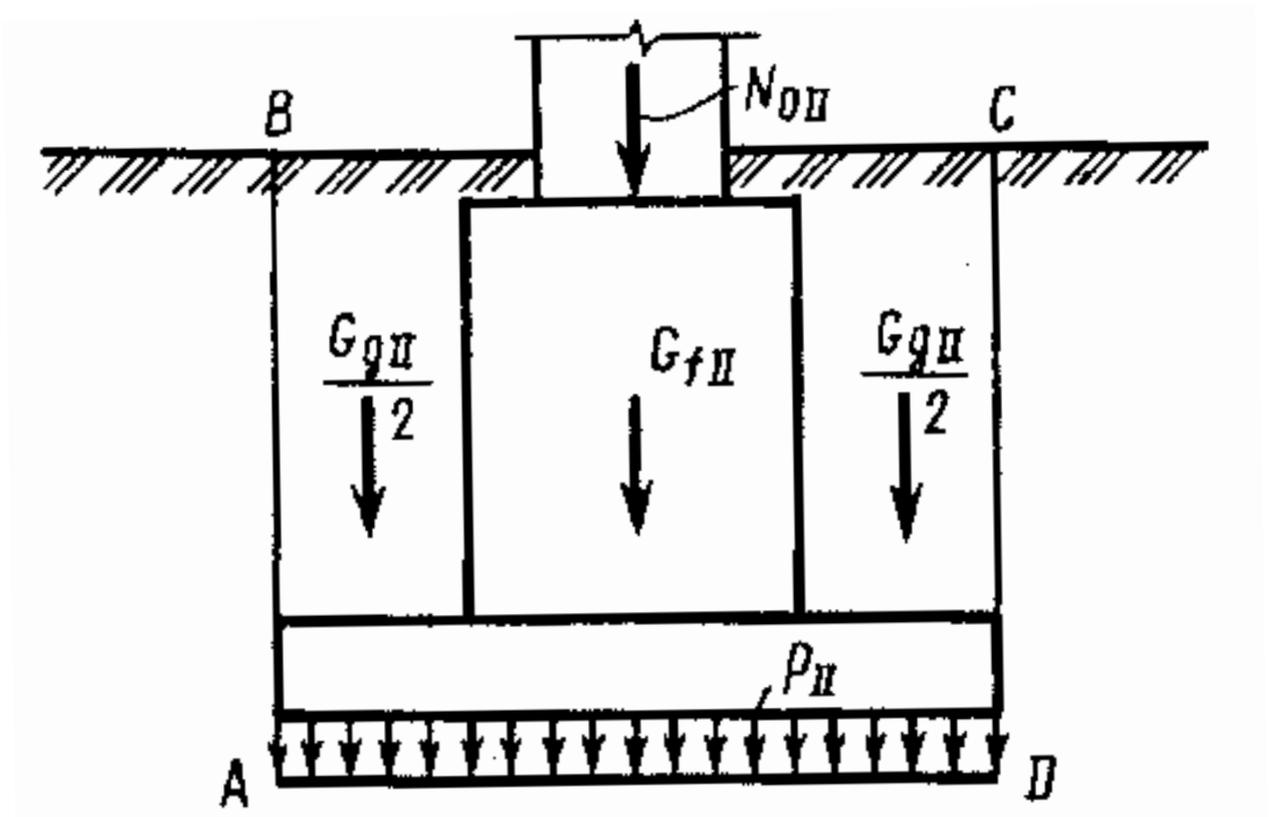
Расчетная схема центрально нагруженного фундамента.
